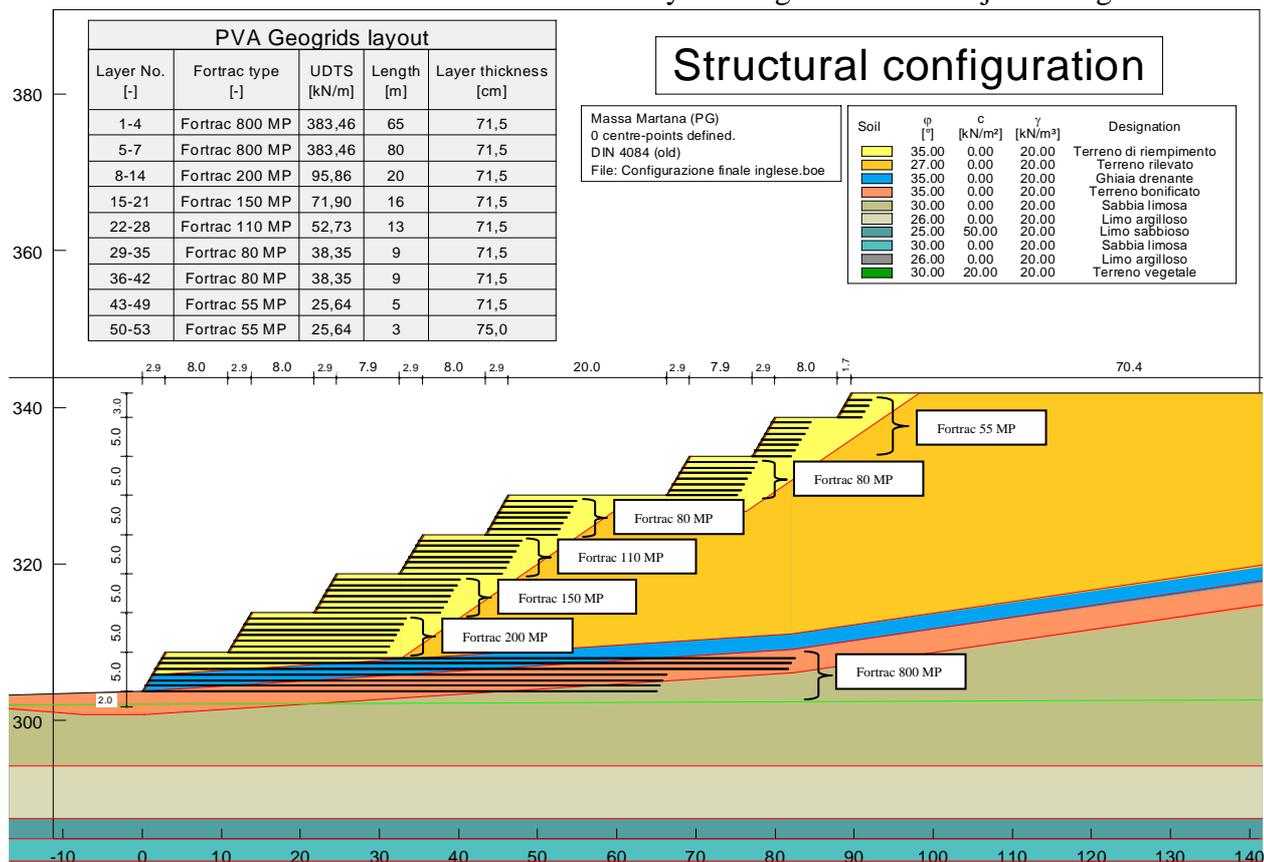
Configuración estructural de la sección crítica del terraplén reforzado.
